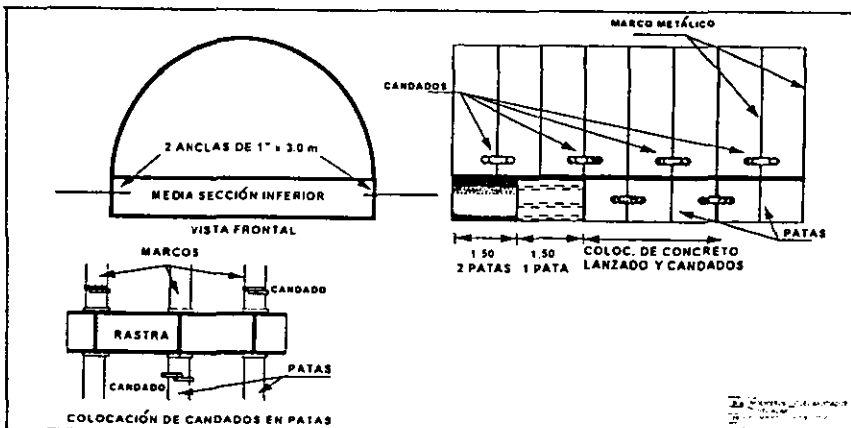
Colocación de candado en patas, longitud de avance y concreto lanzado .
